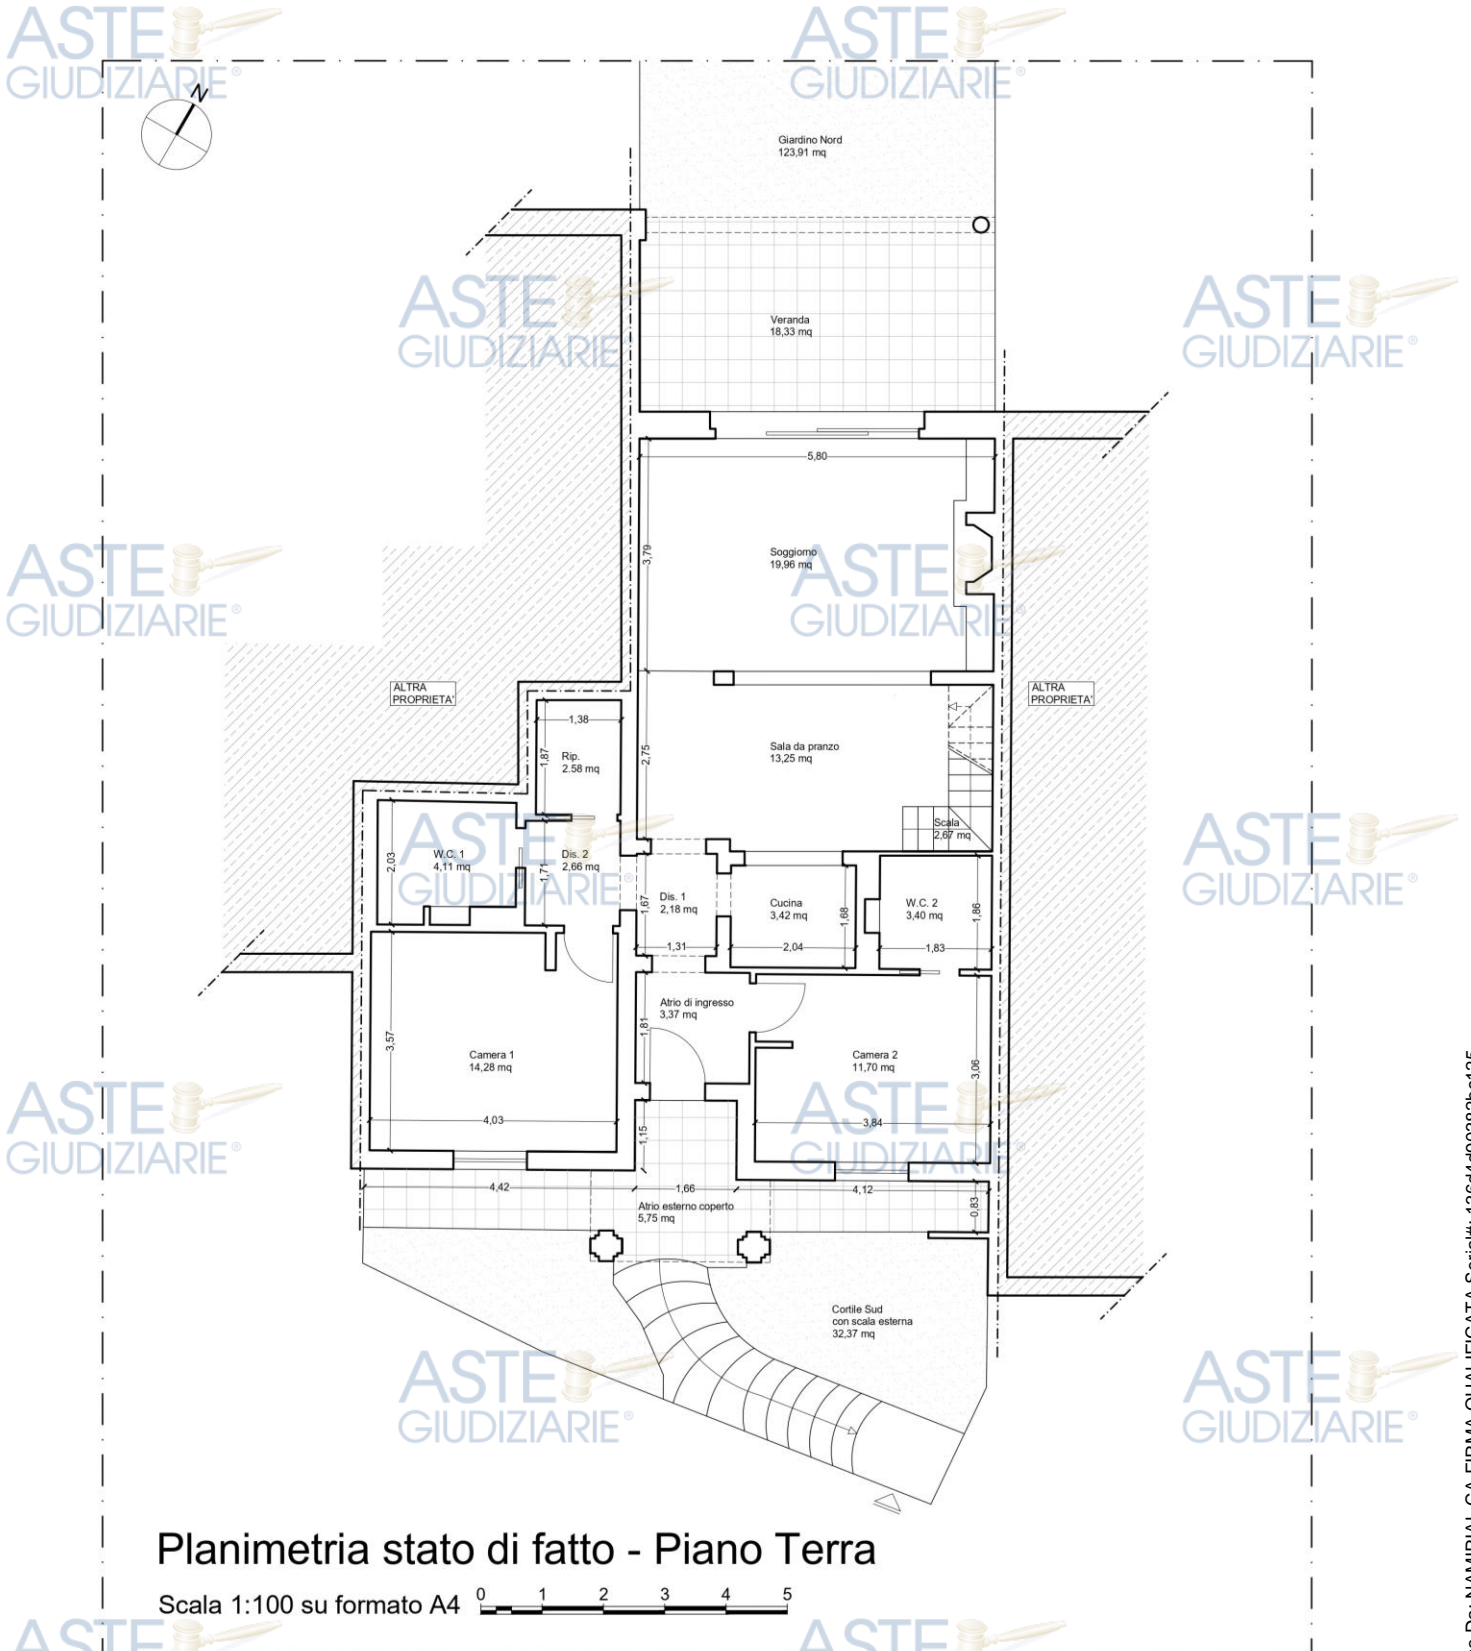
Planimetria dello stato di fatto in scala 1 a 100 – Piano terra
